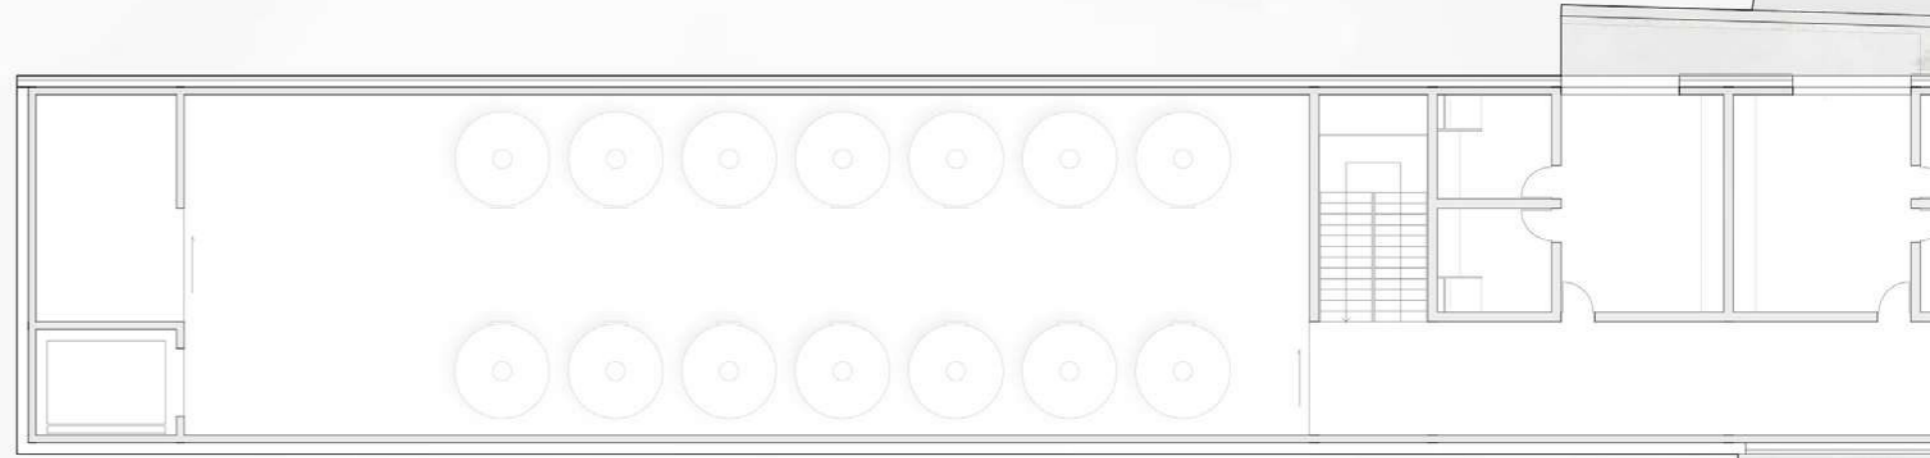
Grundriss 1. Obergeschoss M 1:200
